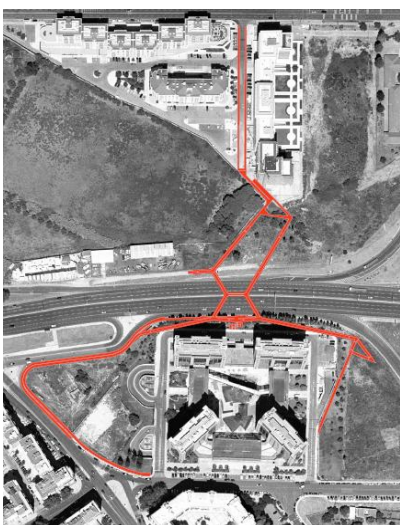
| Planta da Ponte Cor de Laranja que atravessa a 2ª circular e une a zona de Telheiras às Torres de Lisboa, MXT Studios
